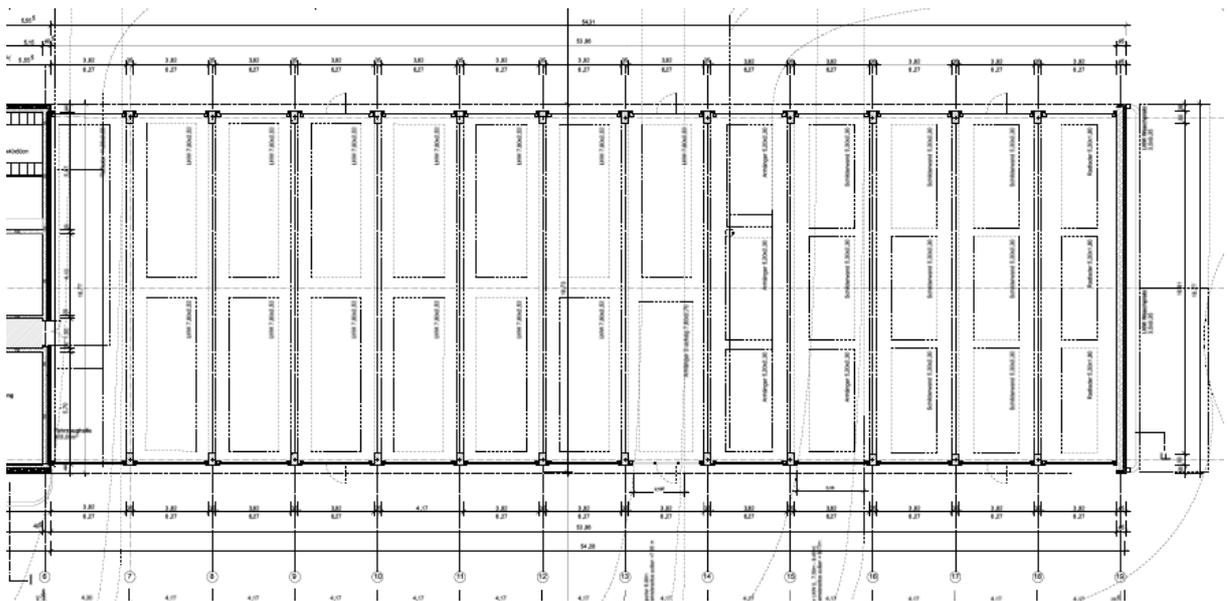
B2 Grundriss Erdgeschoss
